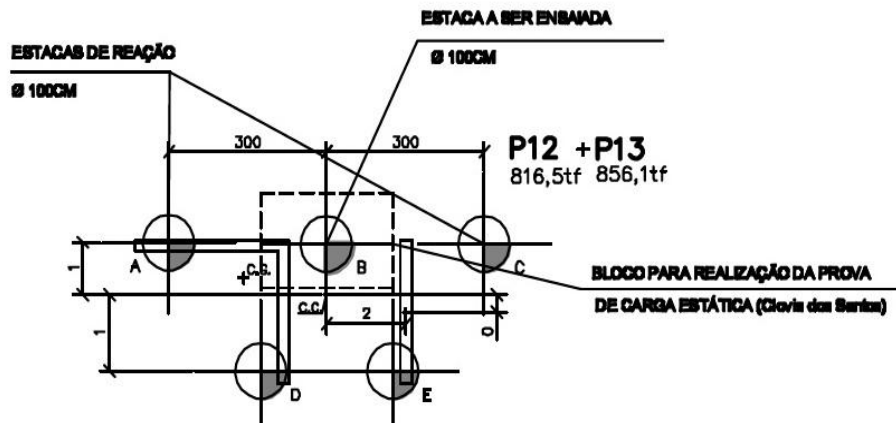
Vista em planta das estacas envolvidas no ensaio.
